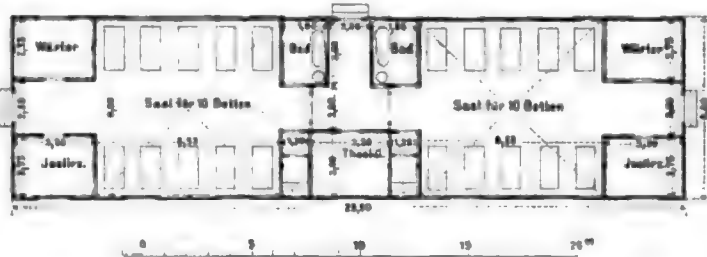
Grundriß der im August geplanten Baracken in St. Pauli und an der Lohmühlenstraße.
